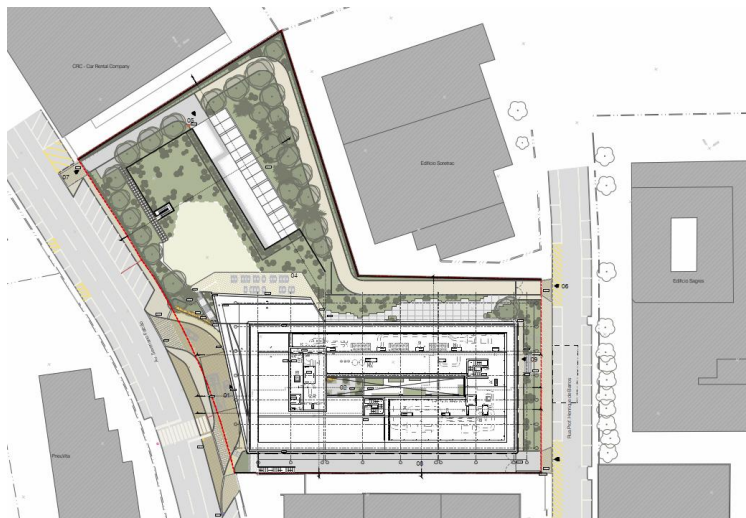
Planta de implantação do projecto de Arquitectura (fonte: “S+A”).
